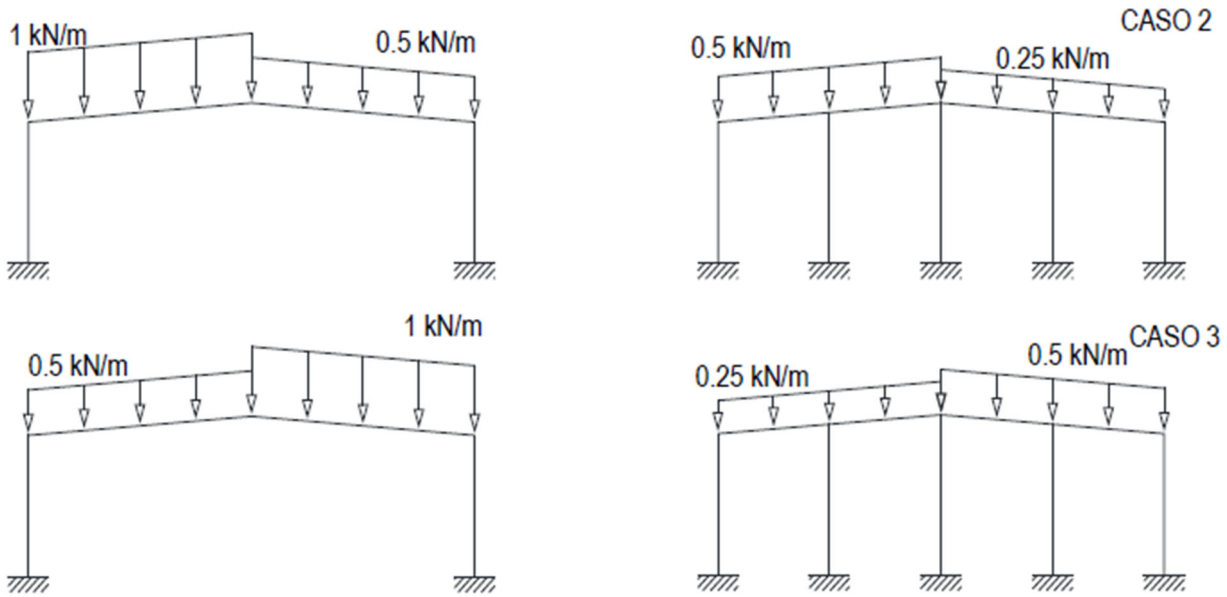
Cargas para pórtico interior y pórtico de fachada.
